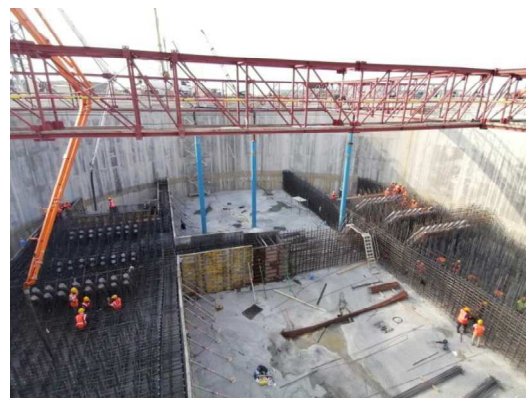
Blocco di ancoraggio, sponda Braila, sezione
